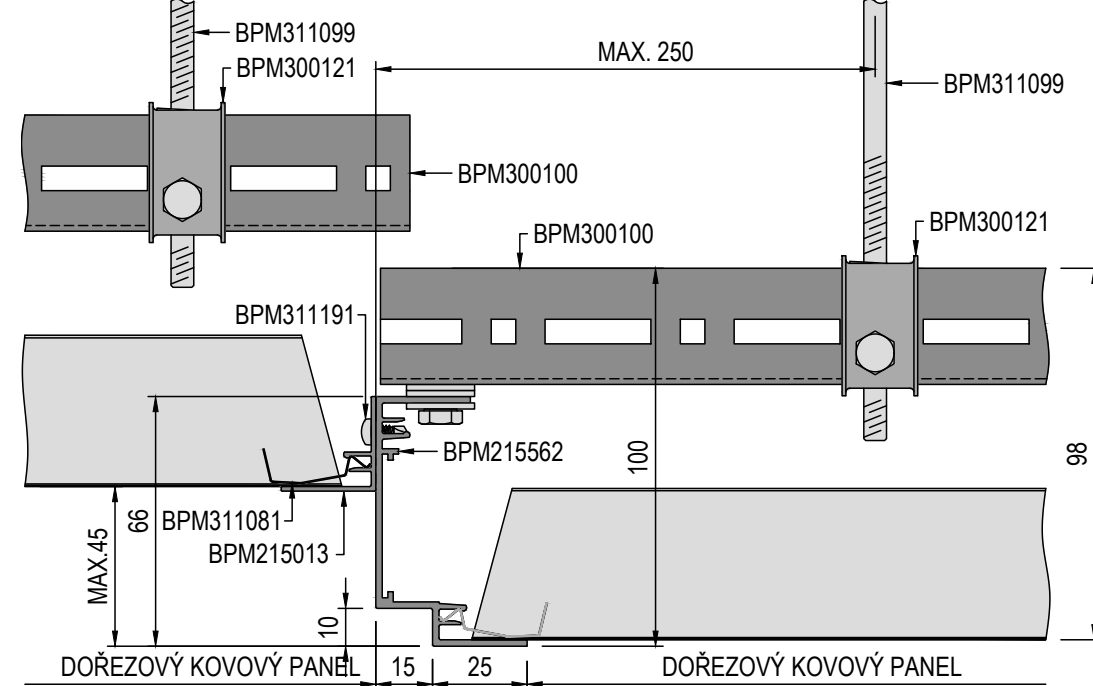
VARIANTA SE STUPŇOVITÝM PROFIEM
